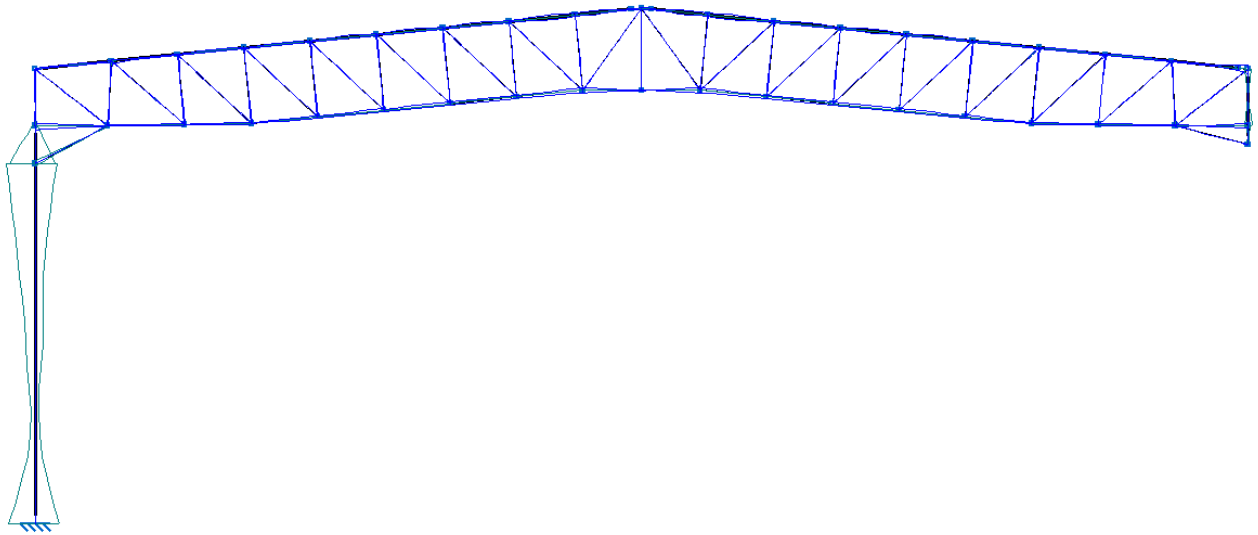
Envolvente de Esfuerzos de Momento. – Pórtico Tipo N°1. Fuente: Elaboración propia.
